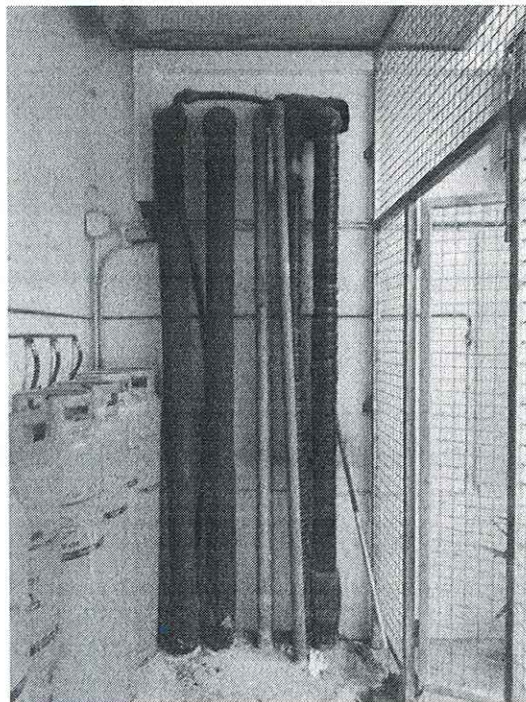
Tuberías a tapar con nuevo cerramiento en interior de la caseta.
